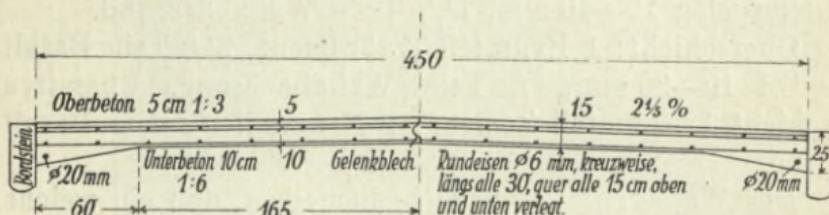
Betonversuchsstraße Groß-Salze-Felgeleben. Straßenquerschnitt 1925.
